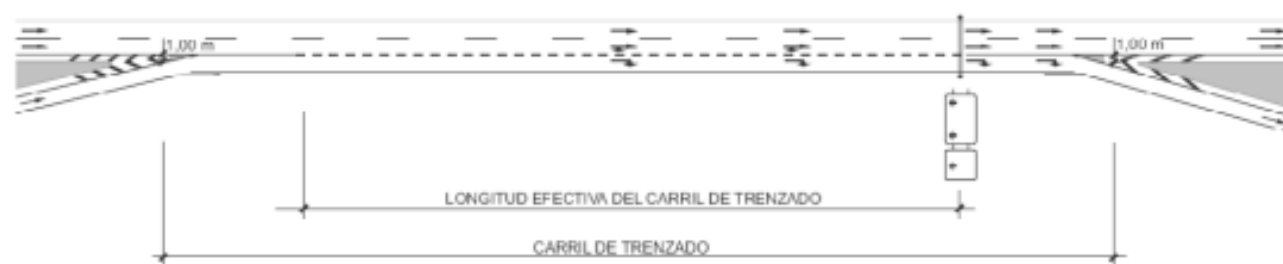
Instrucción de Carreteras 3.1. - IC
